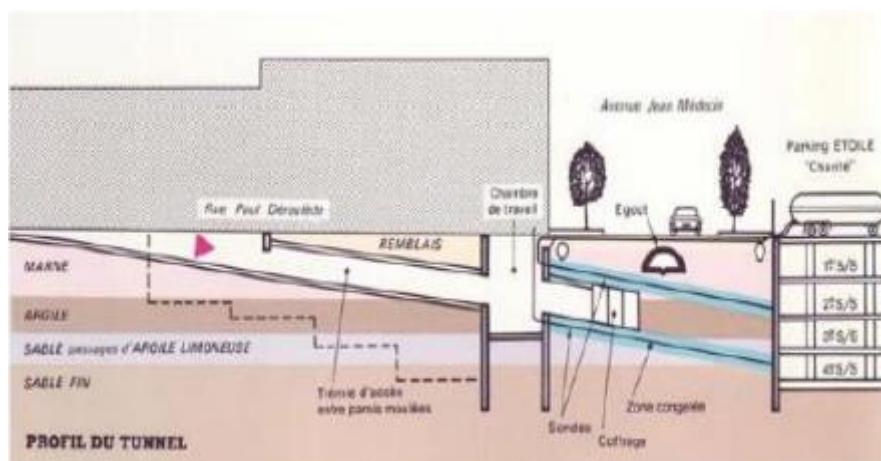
Traitement par congélation à Nice d'une zone sous chaussée traversée en tunnel
